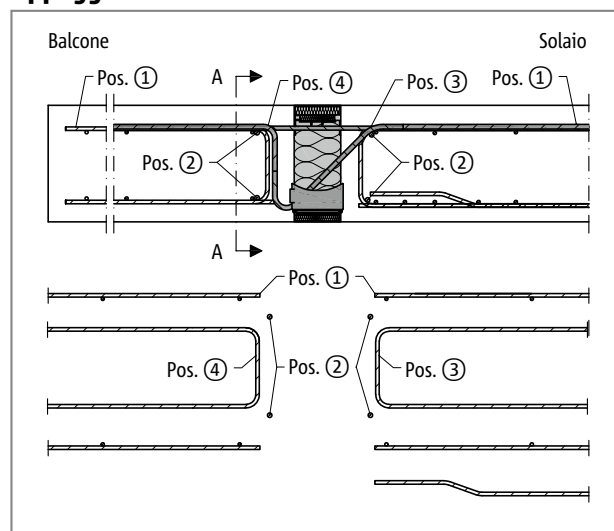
Schöck Isokorb® T tipo KL: armatura in opera con appoggio indiretto
